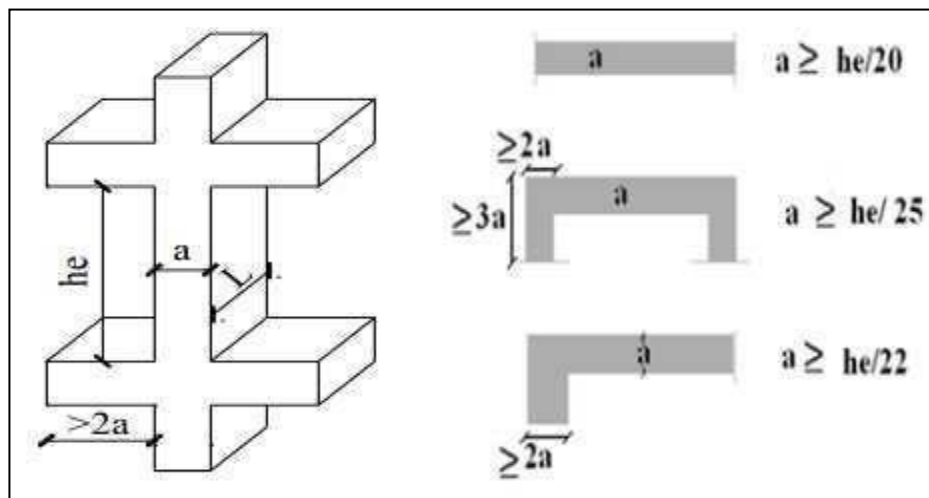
Coupe de voile en plan (droite) Voile en 3D (gauche).
